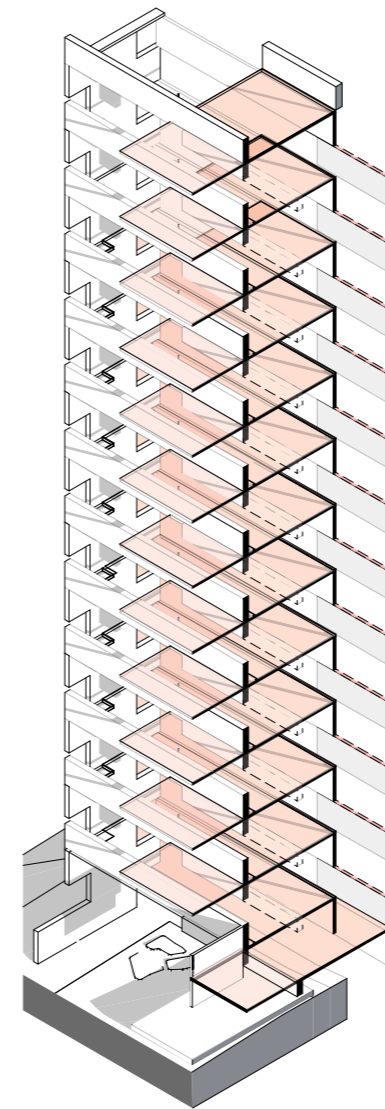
SECCIÓN AXONOMÉTRICA SISTEMA VIGA / LOSA / VIGA
